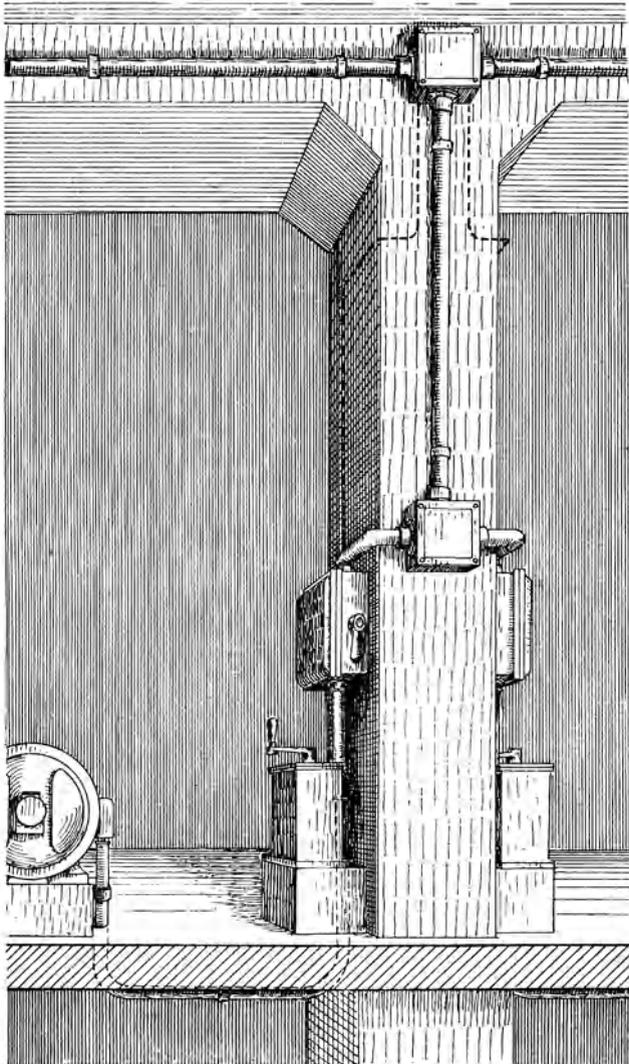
Motorinstallation in Stahlpanzerrohr.
